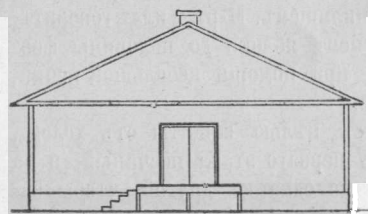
Фасадъ того же плодохранилища съ крыльцомъ.
